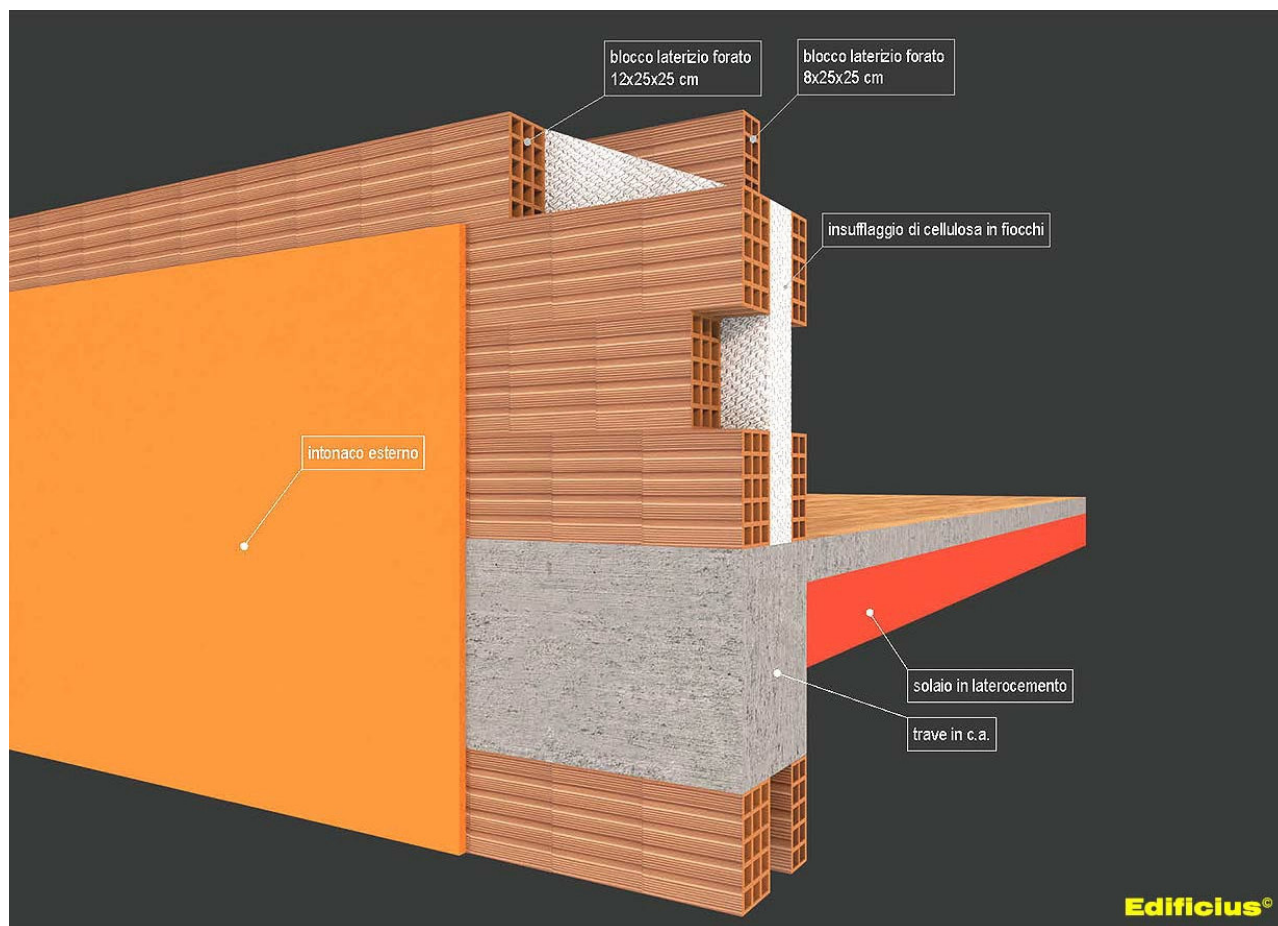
Esempio di una parete perimetrale con intercapedine riempita mediante insufflaggio di cellulosa in fiocchi
